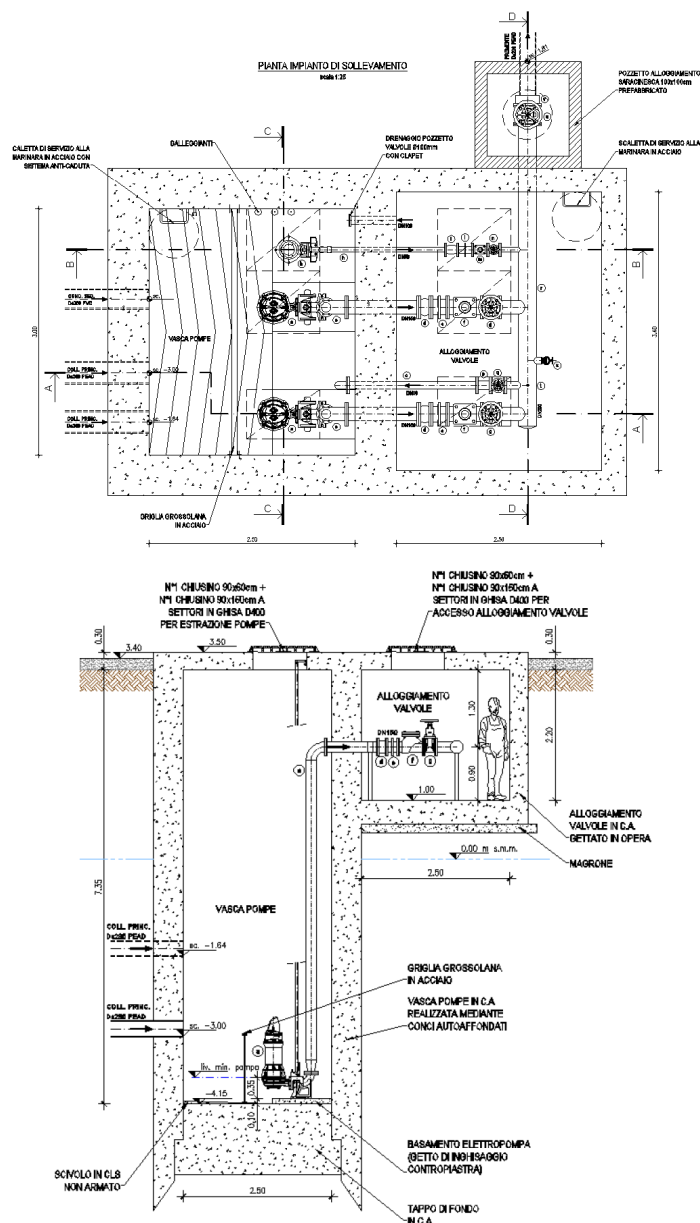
Pianta e sezioni impianto di sollevamento S8
